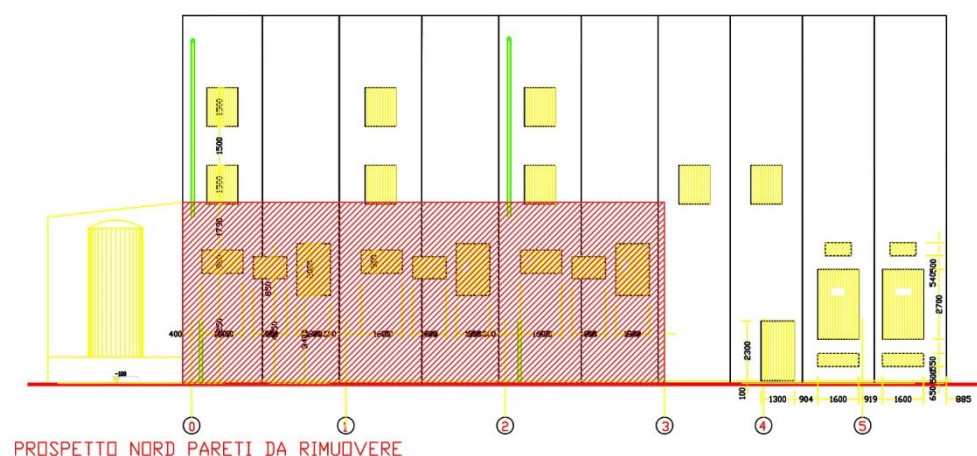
Impianto BL1 – Prospetto con moduli da rimuovere
